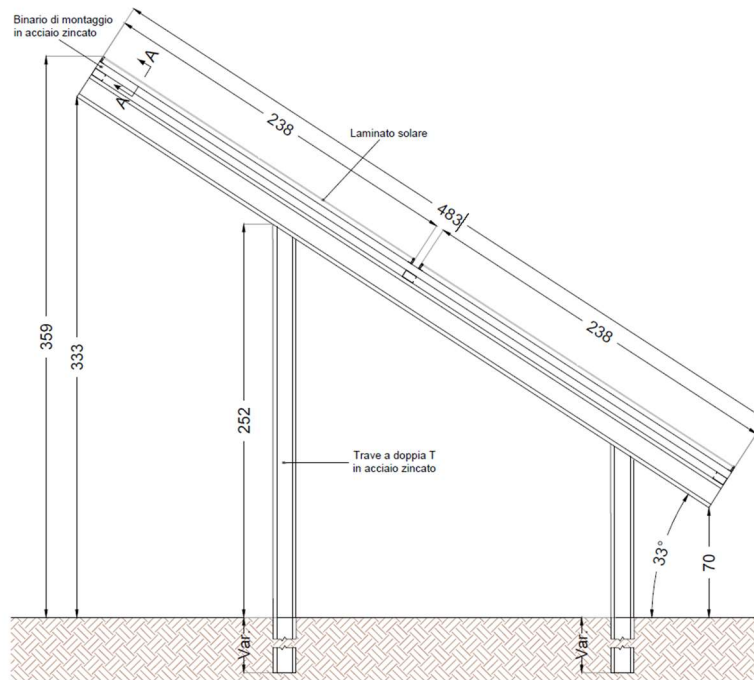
Sezione tipo di struttura fissa – misure in cm
